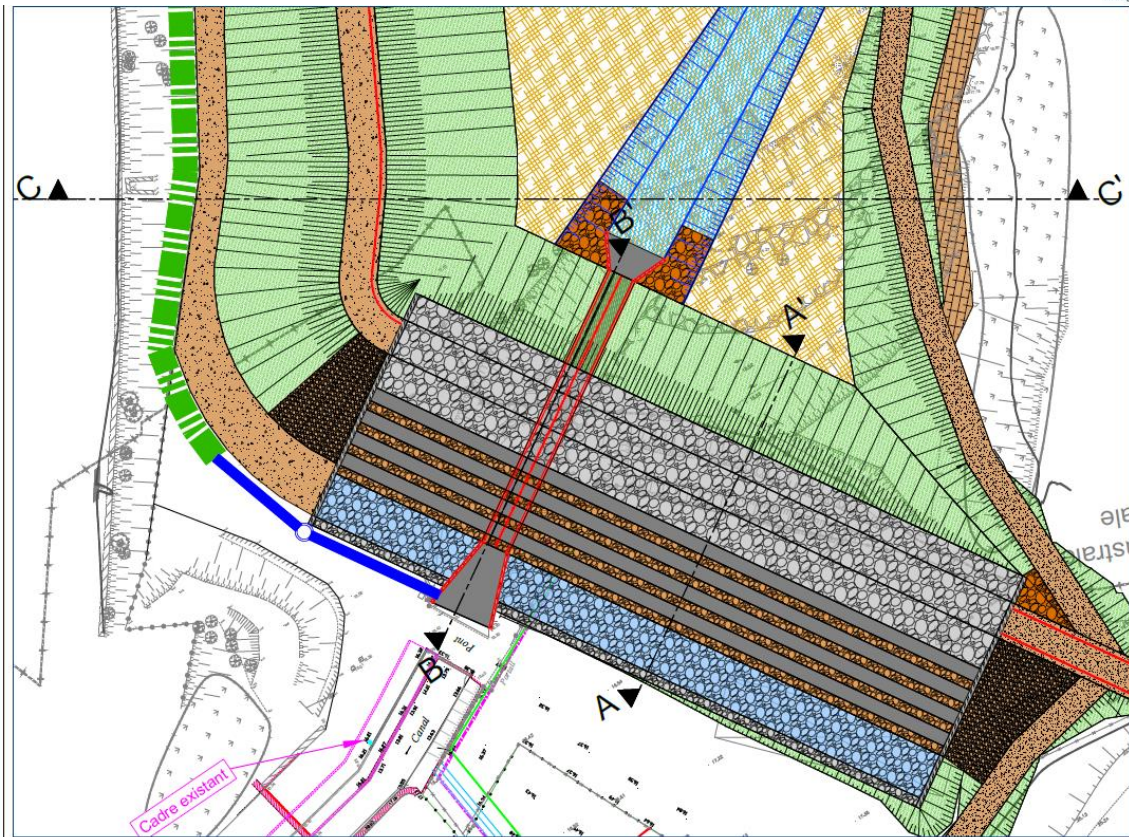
Localisation des coupes sur la section courante et sur la section déversante de l'aménagement hydraulique – plan AVP
